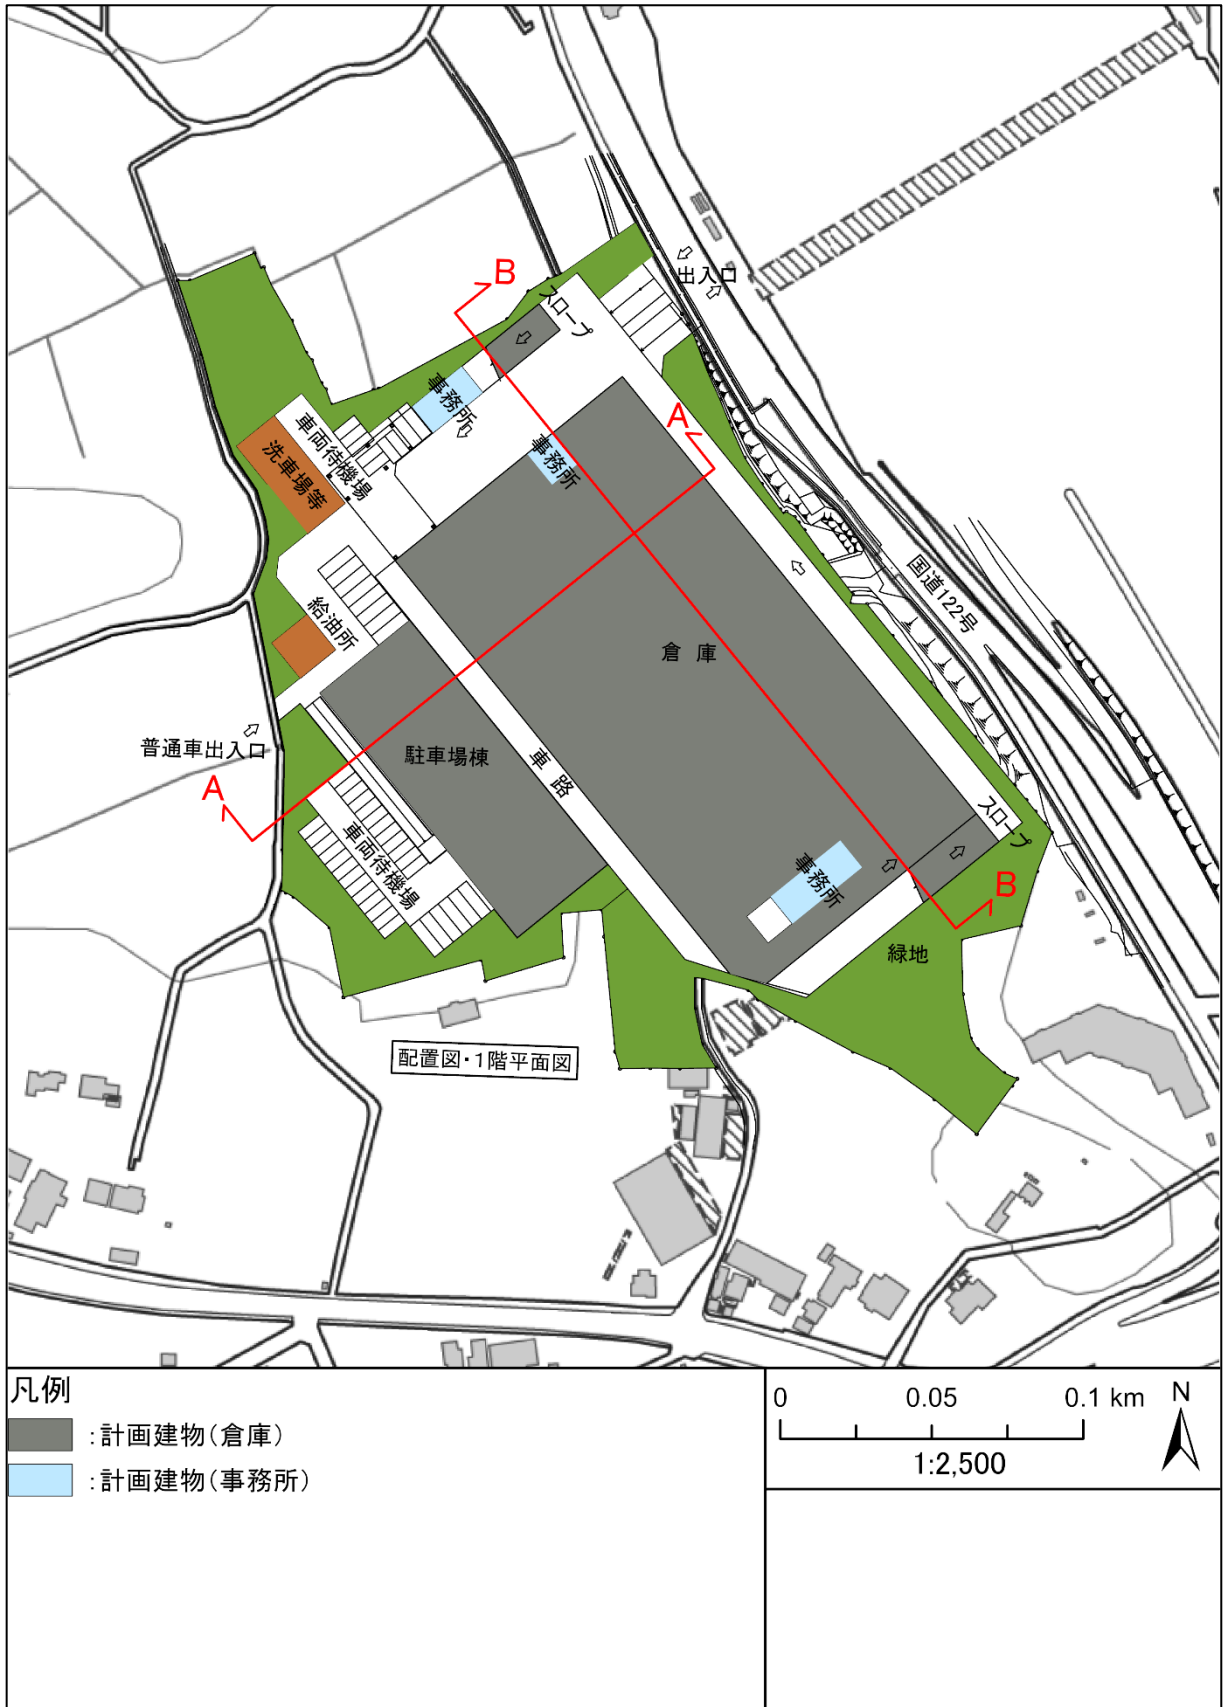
(1) 計画施設の配置計画図および1階平面図(評価書時点)
